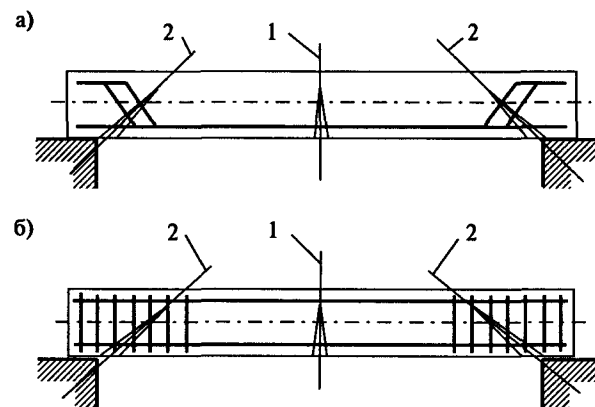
Схемы армирования железобетонных балок: а) отгибами продольной арматуры на опорах; б) поперечными стержнями (хомутами) на приопорных участках; 1 — нормальное сечение; 2 — наклонное сечение;
